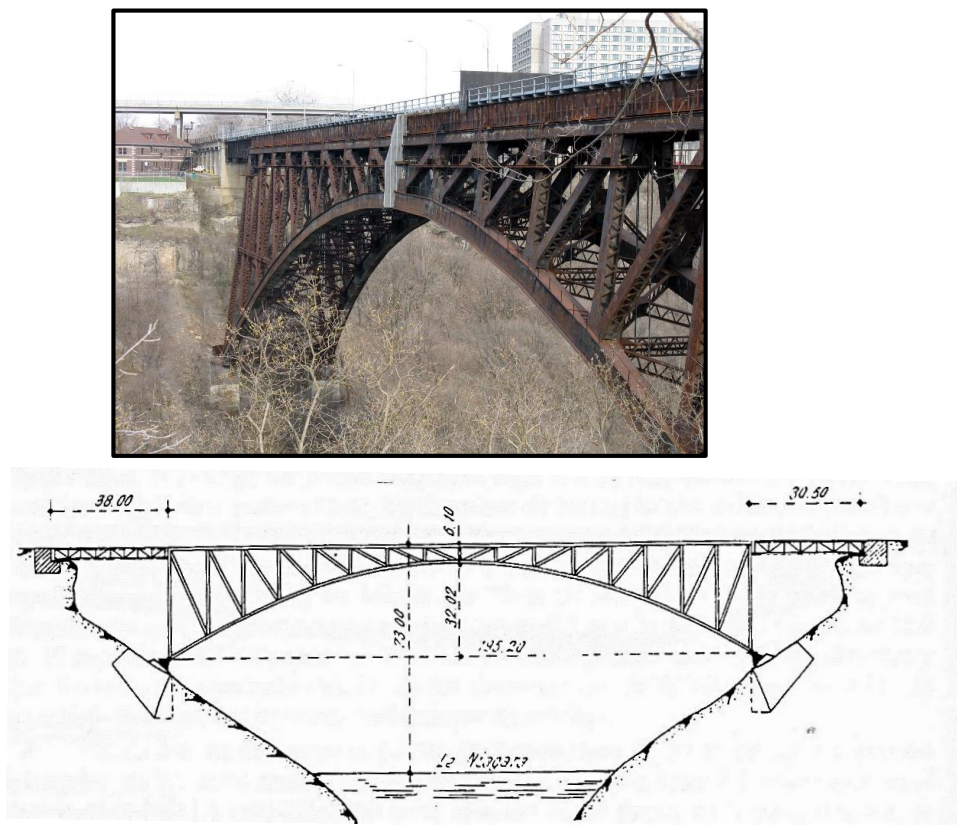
Michigan Central Railway Bridge, Michigan, E.U.A. (1925) [1].
